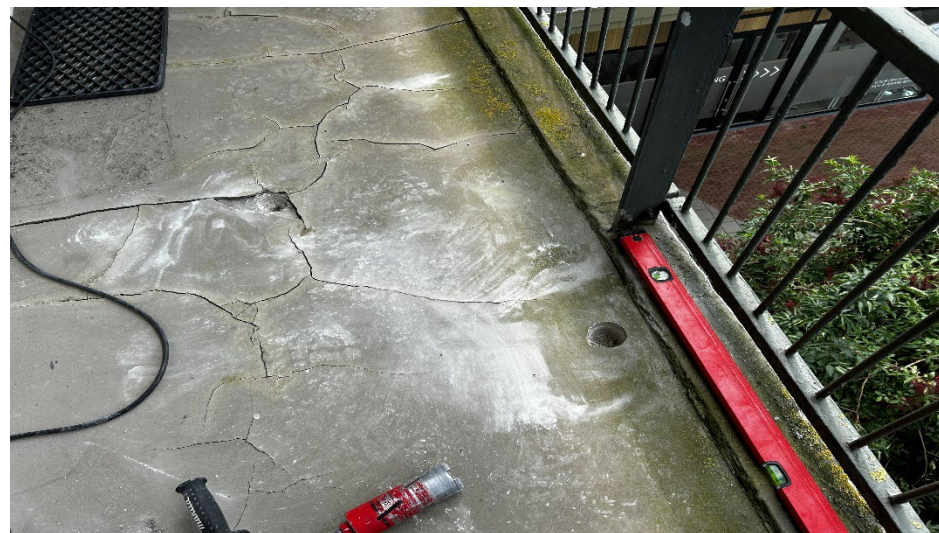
Technisch Onderzoek – Locatie kernboring – 1e nabij schrobrand en 2e in een scheur.
